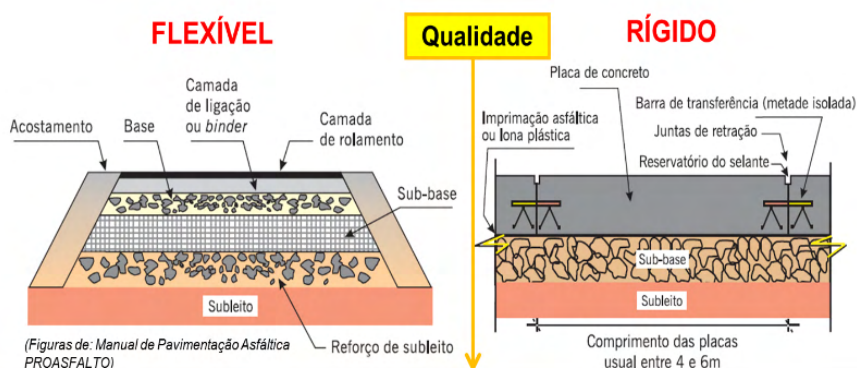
Diferença estrutural entre pavimentos rígidos e flexíveis.
